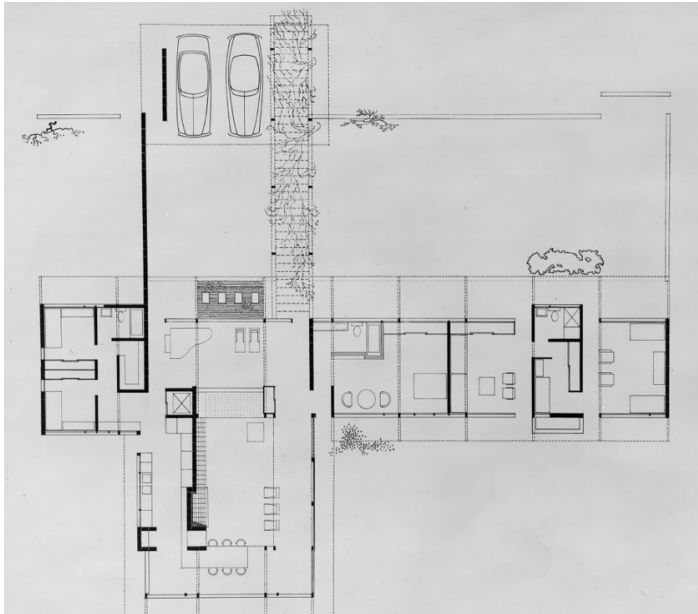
Planta de la residencia Miller. *Paul Rudolph Heritage Foundation
